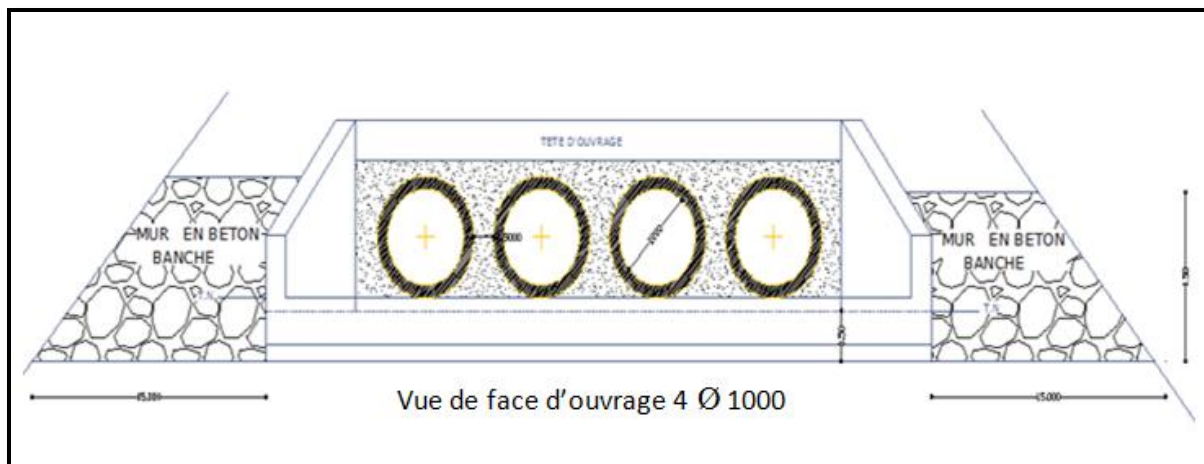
4:vue de face d'un ouvrage batterie (4 Ø = 1000 mm).
